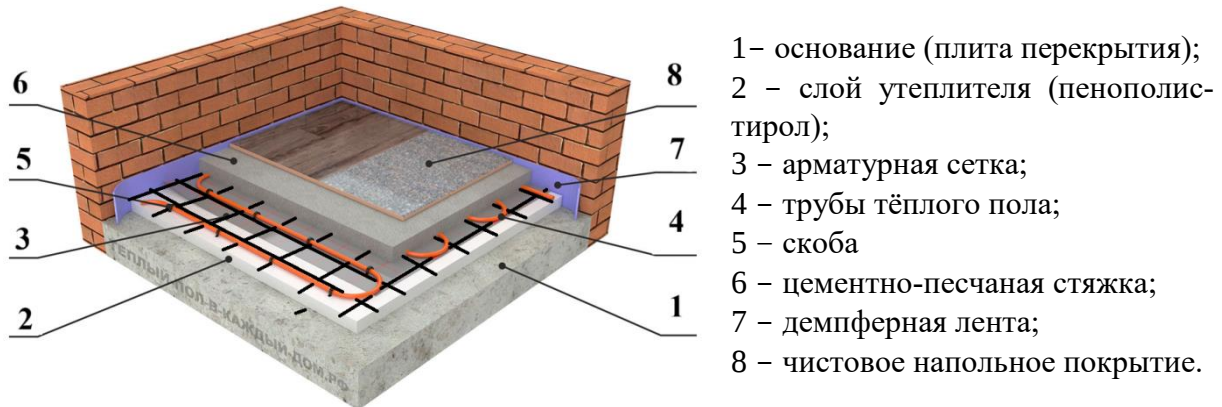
Конструкция «мокрого» тёплого пола
